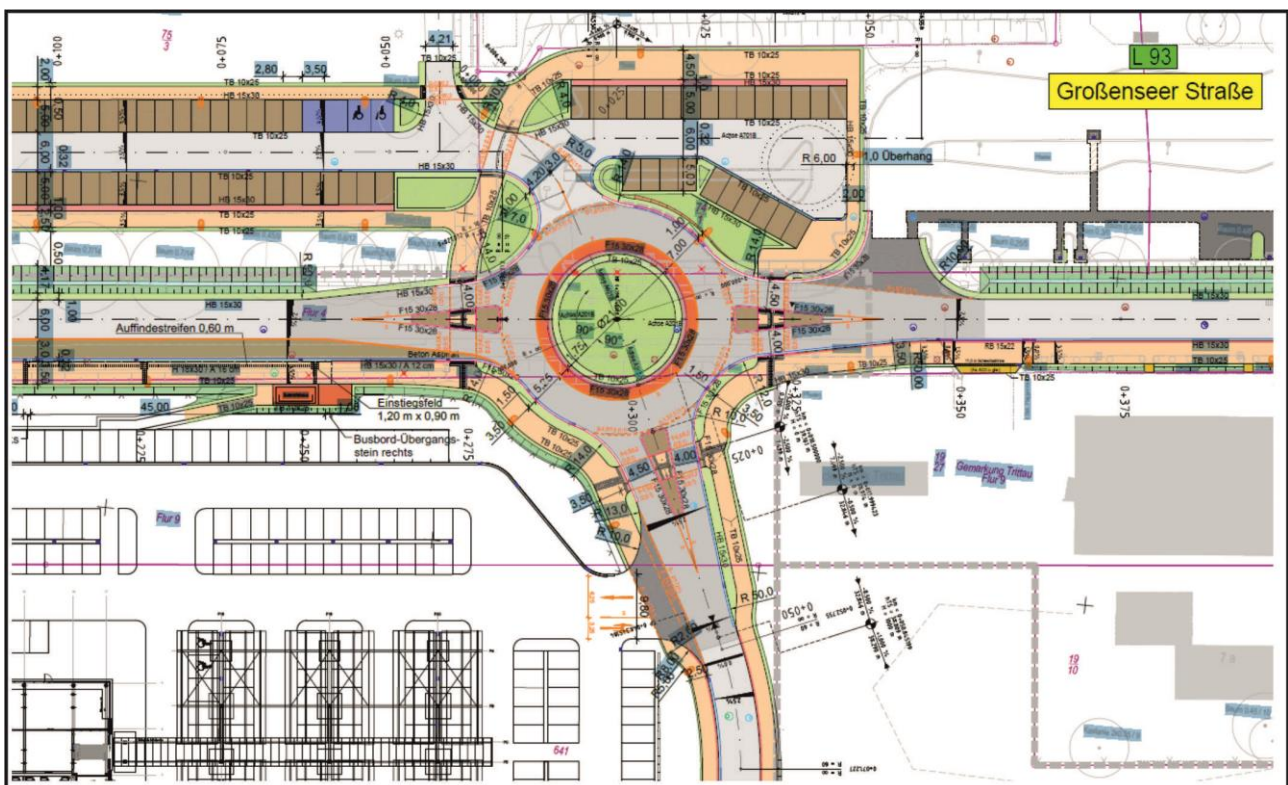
Umbau der Großenseer Straße mit Kreisverkehr und Anschluss an den B-Plan 35B
